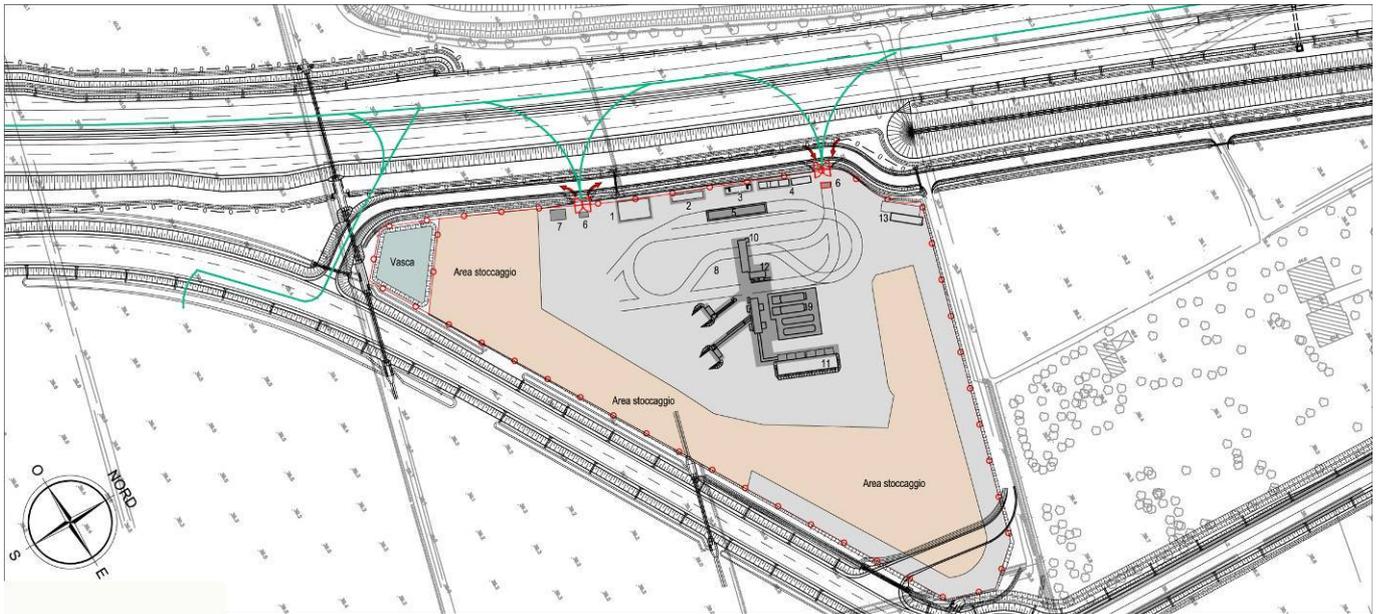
Planimetria del cantiere PV del Progetto Esecutivo e relativa legenda.
